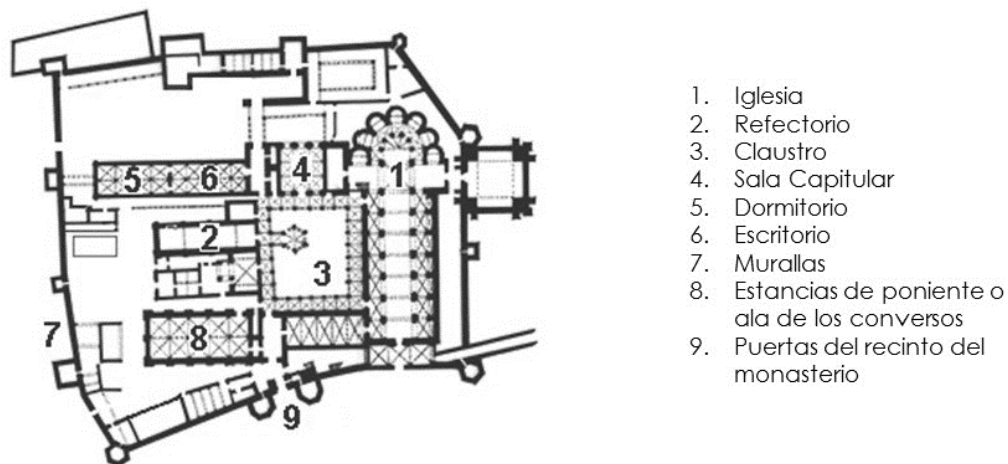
Plano del Monasterio de Poblet. Fuente: plano adaptado de la web del monasterio(Pla 1980)
